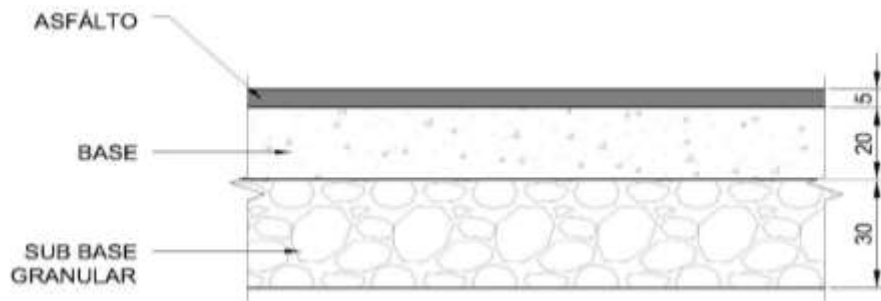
Esquema de la sección de estructura propuesta de pavimento flexible
